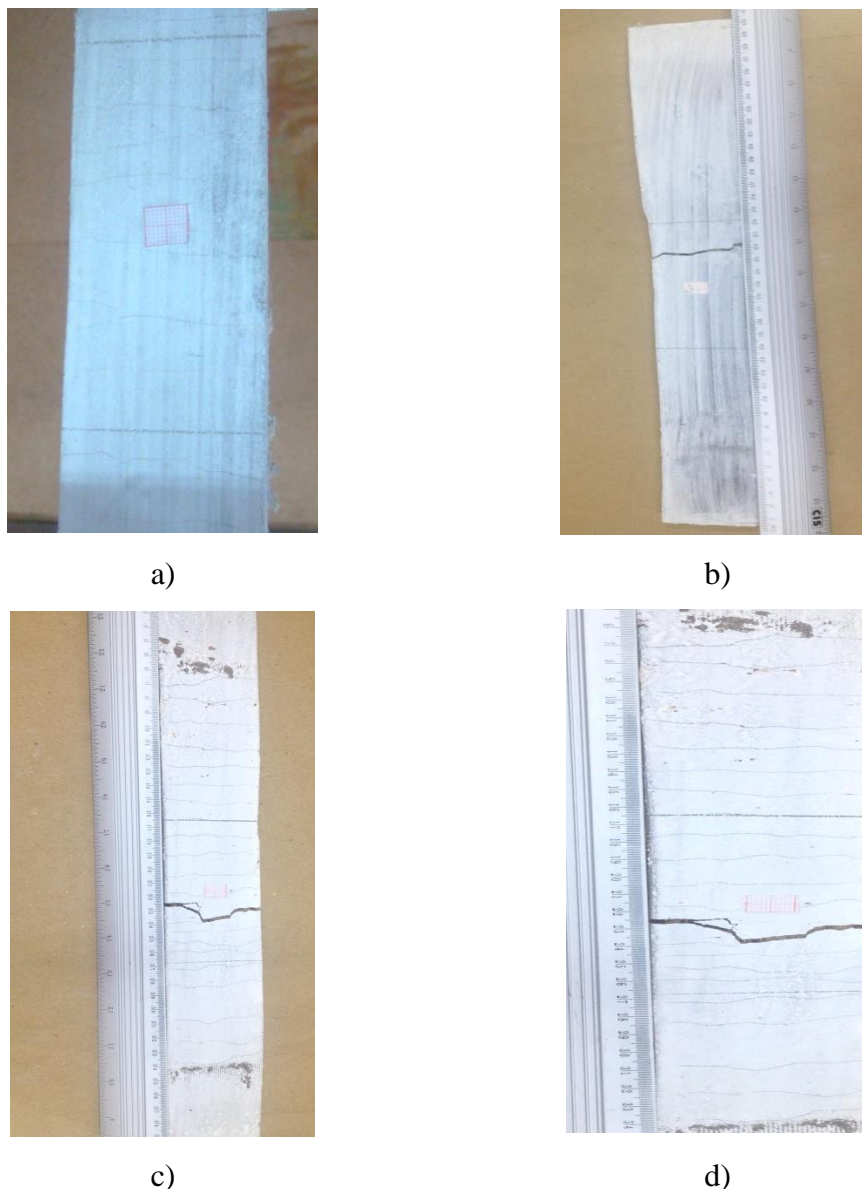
Imagens de amostras após o ensaio de tração direta: a) Amostras ensaiadas no equipamento e formação das fissuras; b) Após ensaio apenas as fissuras maiores ficavam em evidência; c) Marcação com lápis para melhor visualização da fissura; d) Detalhe das fissuras
